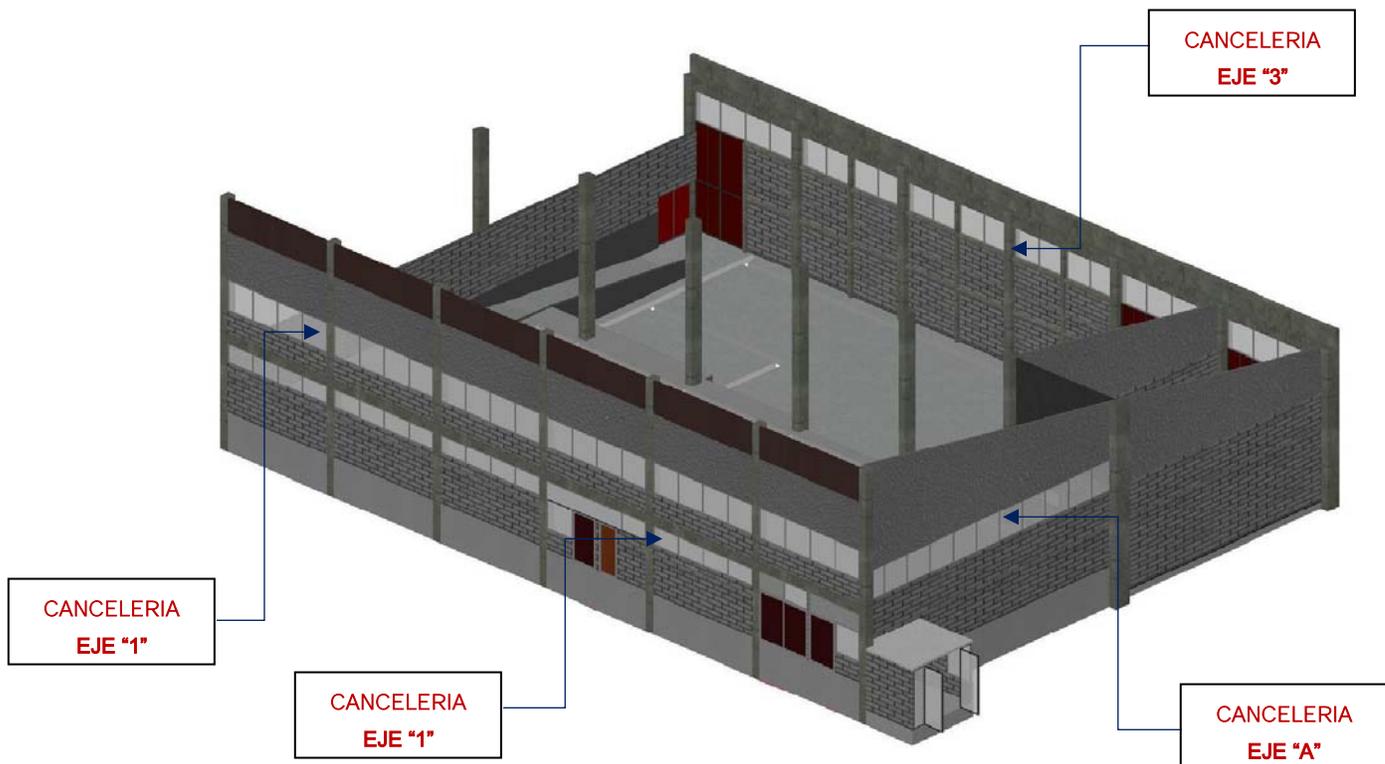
Modelo 3D-Cancelería en Planta Piloto.
